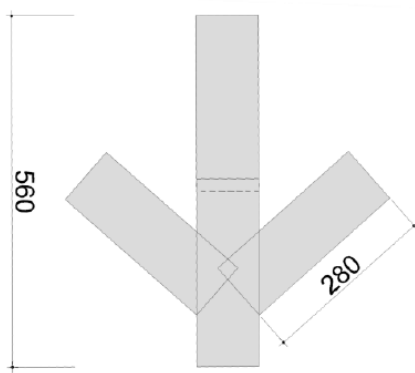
Detalhe da viga contraforte posicionada na zona de intersecção entre poços (Silva *et al.*, 2014).
